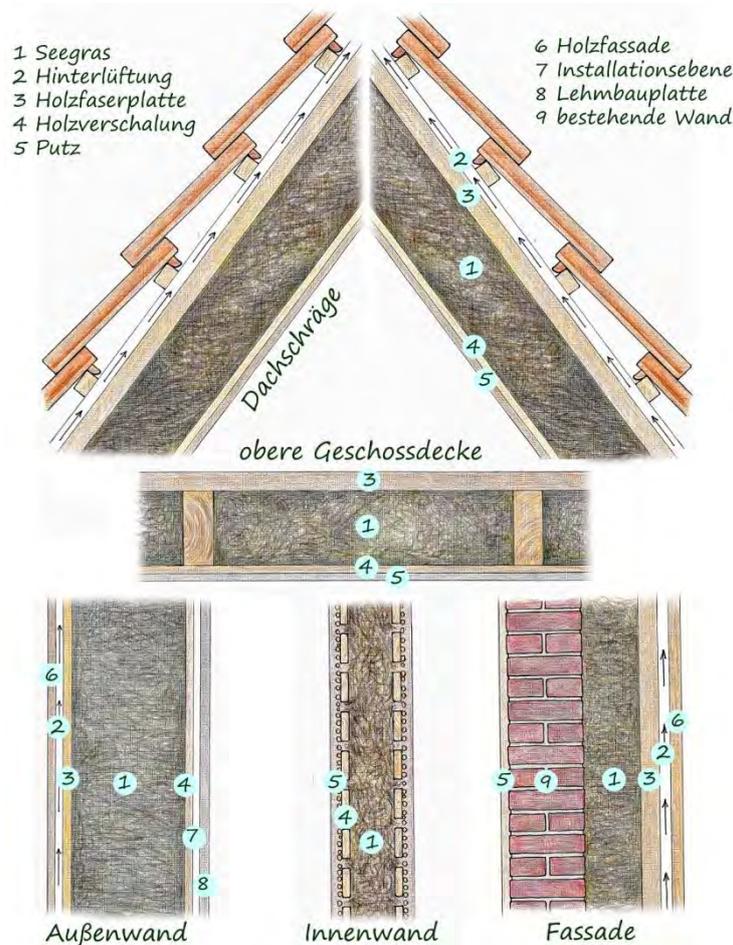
Die verschiedenen Dämmvarianten mit Seegras: Dachschräge, obere Geschossdecke, Innenwand, Fassade und Außenwand (Swantje Streich)
